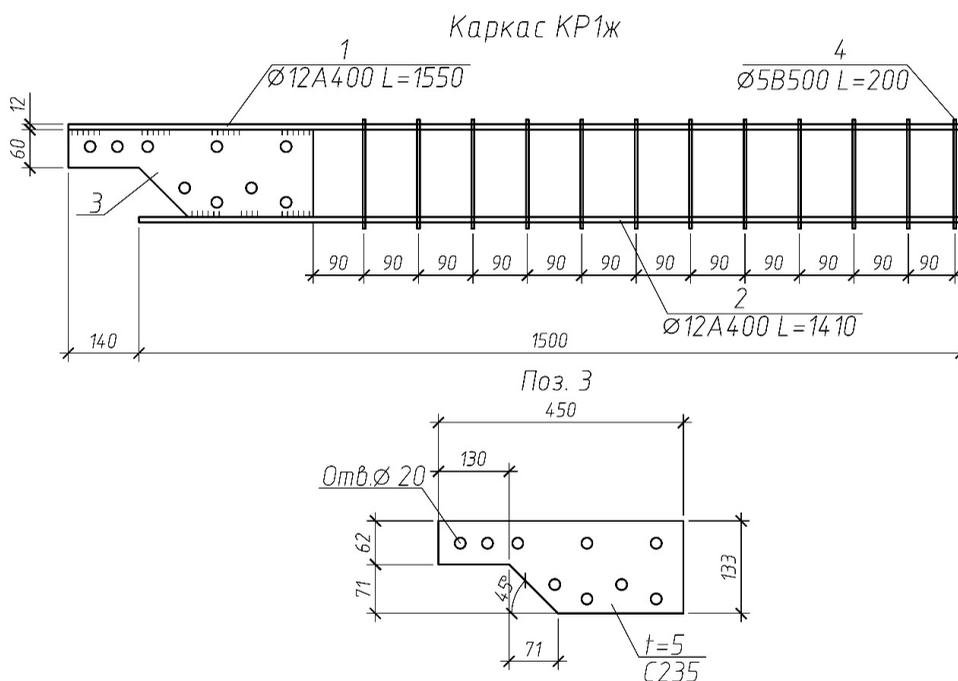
Конструктивное исполнение каркаса для поперечного армирования плиты, вариант 4
